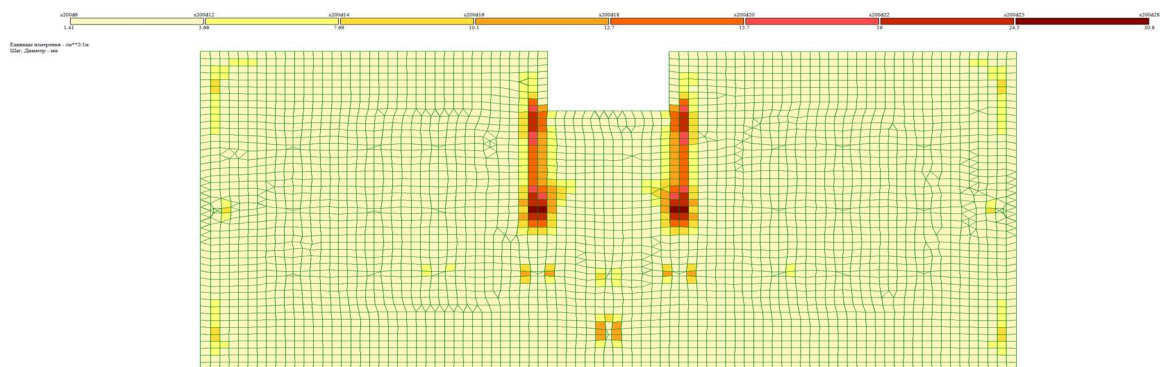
Нижнее армирование плиты фундамента по оси X
